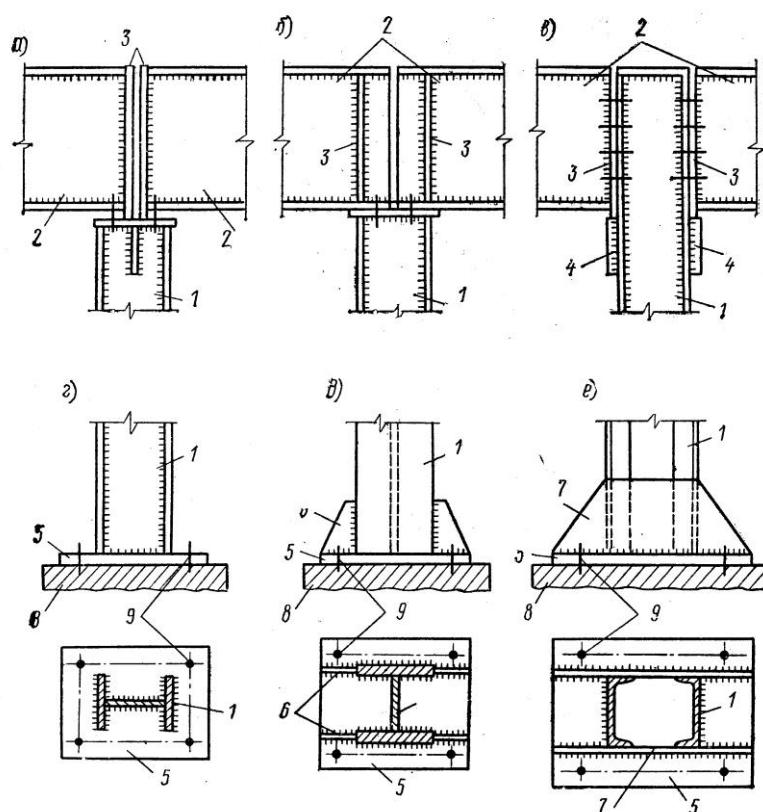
Конструкция оголовка и базы колонн: а - оголовок при передаче нагрузки от балок через торцовые ребра; б - то же, через ребра, расположенные против полок стержня колонны; в - оголовок при примыкании балок сбоку и передаче нагрузки на столик; г - база из одного опорного листа; д - база из опорного листа и ребер; е - база из опорного листа и траверс; 1 — стержень колонны; 2 - балки; 3 - опорные ребра балок; 4 - столик; 5 - опорный лист; 6 - ребра; 7 - траверсы; 8 - фундамент; 9 - анкерные болты
